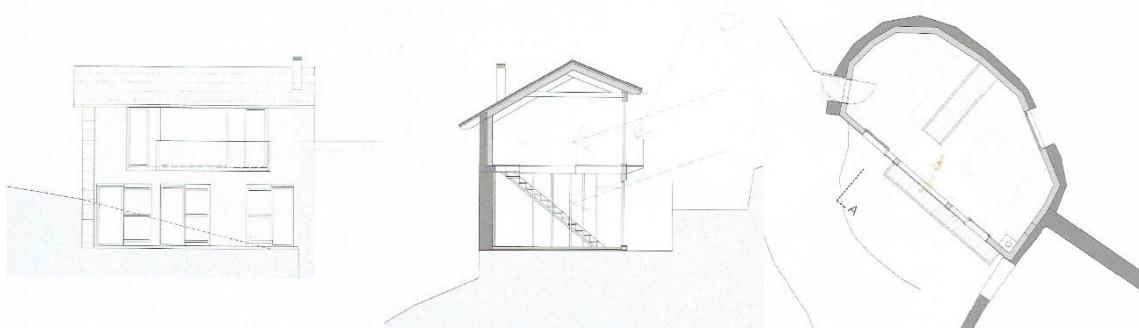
Alzado, sección y planta primera [Libro Josep Bunyesc. Arquitectura Positiva]
